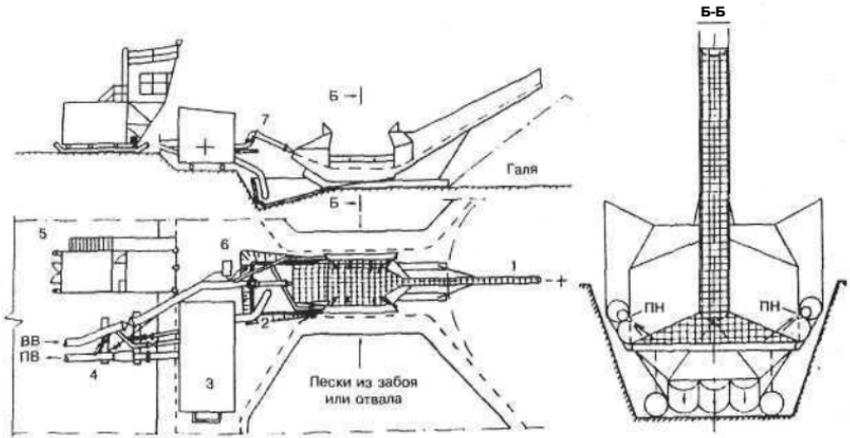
Компоновка гидроустановки при двухсторонней подаче песков на гидровашгерд: 1-гидровашгерд с пассивными насадками, расположенными с двух сторон размывочной решетки; 2-зумпф-кузов; 3-землесосная станция; 4-блок разводки; 5-пульт управления и ЗРУ; 6-дренажный насос; 7- гидромонитор ГМД-250; ВВ - водовод; ПВ - пульповод
